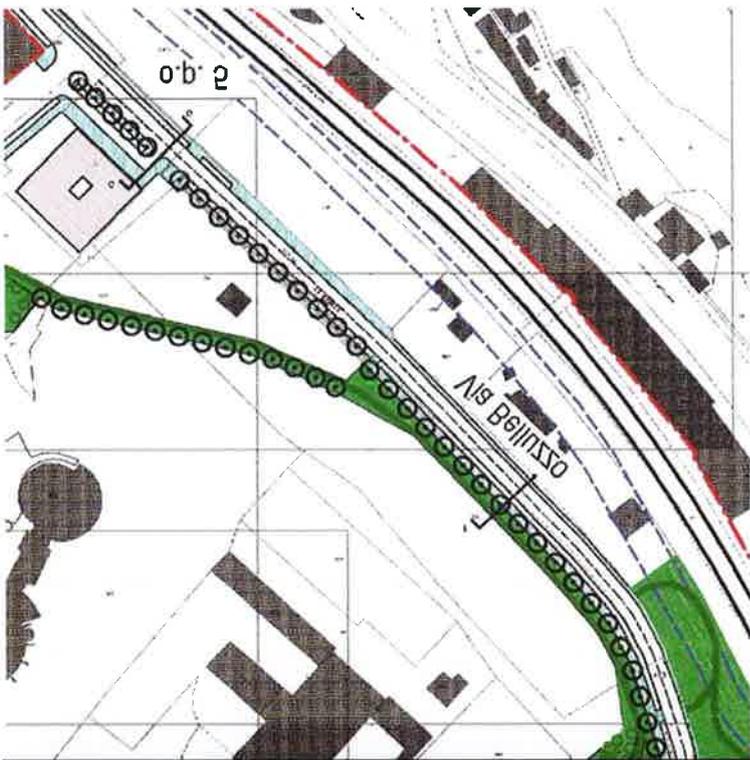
Indirizzamento dimensionale dell'area di intervento.
